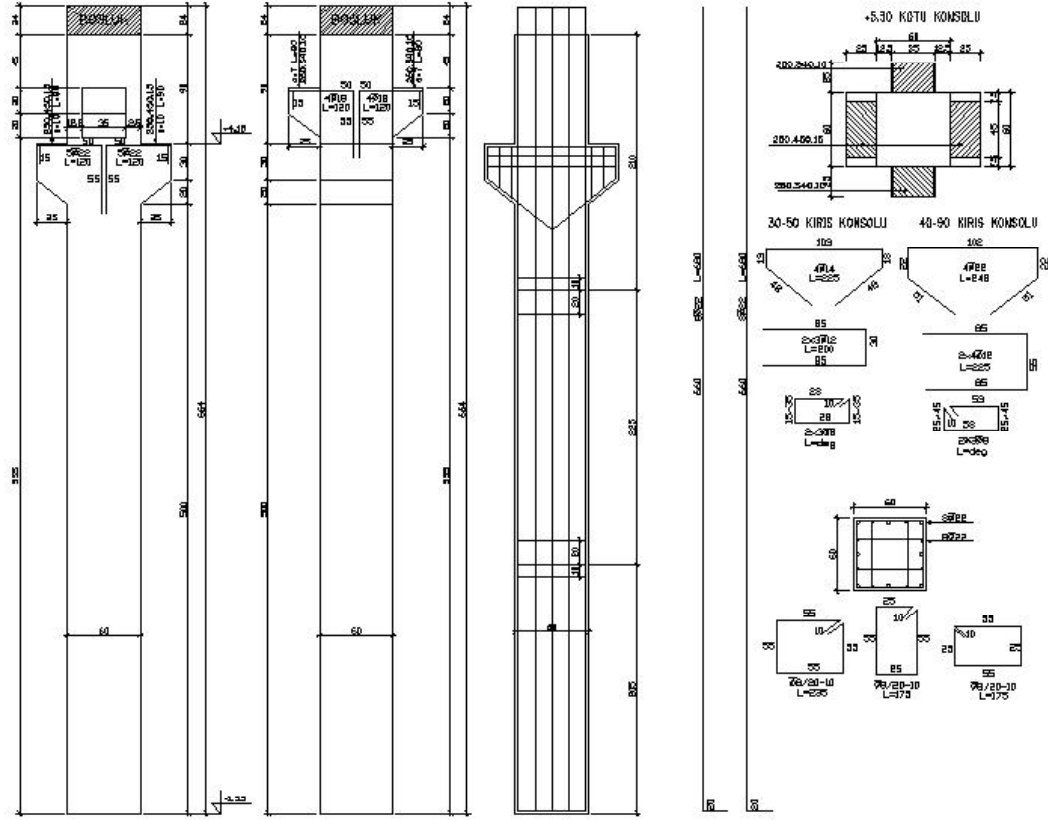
Prefabrike sanayi yapısı S1A kolonu detayı
